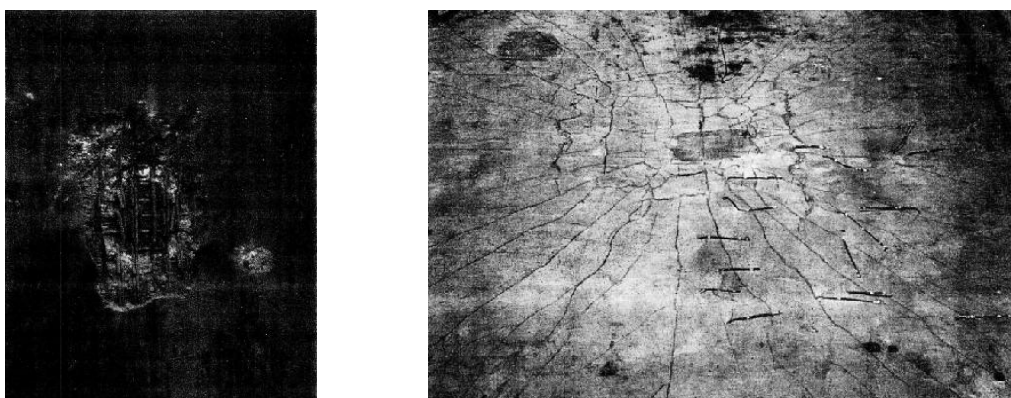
Endommagement de la dalle à la fin de l'essai : face avant (à gauche), face arrière (à droite).
